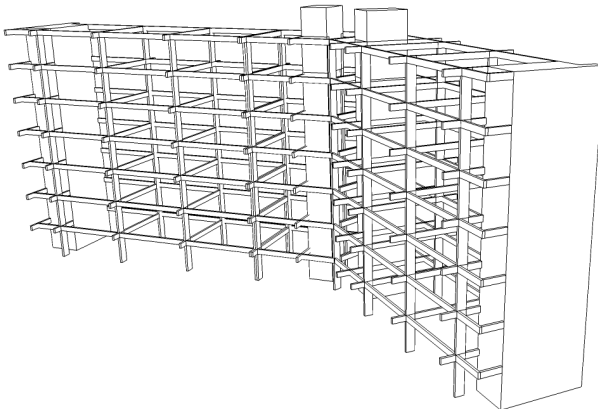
Esquema estructural edificio de oficinas (mismo criterio estructural para el edificio dormitorio).
